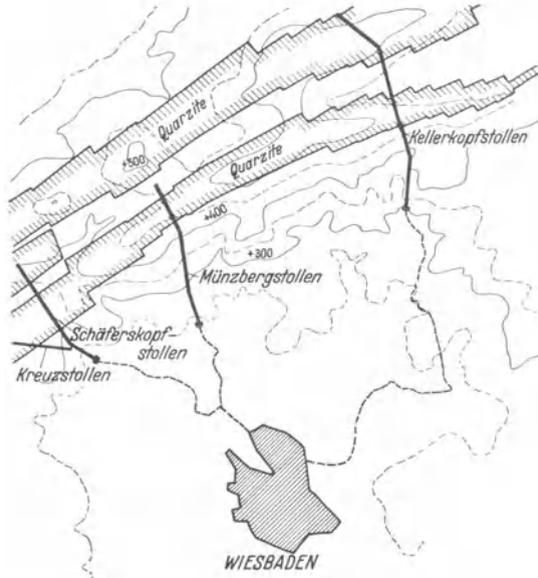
Lageplan der Stollenfassungen der Stadt Wiesbaden. (Nach Halbertsma und Spieser.)
